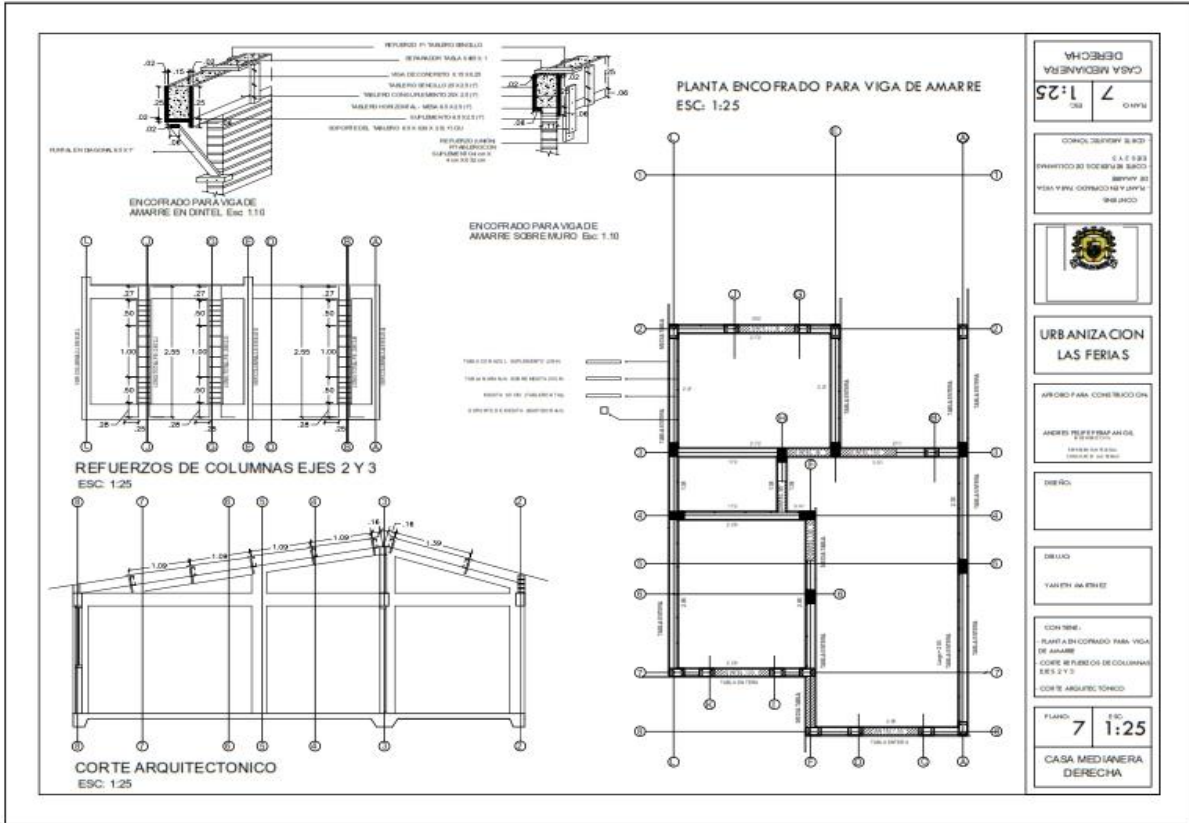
Planta encofrada para viga de amarre, corte de refuerzo de columnas eje 2 y 3.
